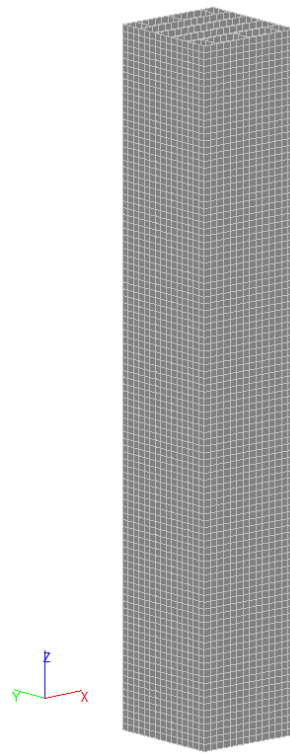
Схема ядра жесткости на всю высоту здания
